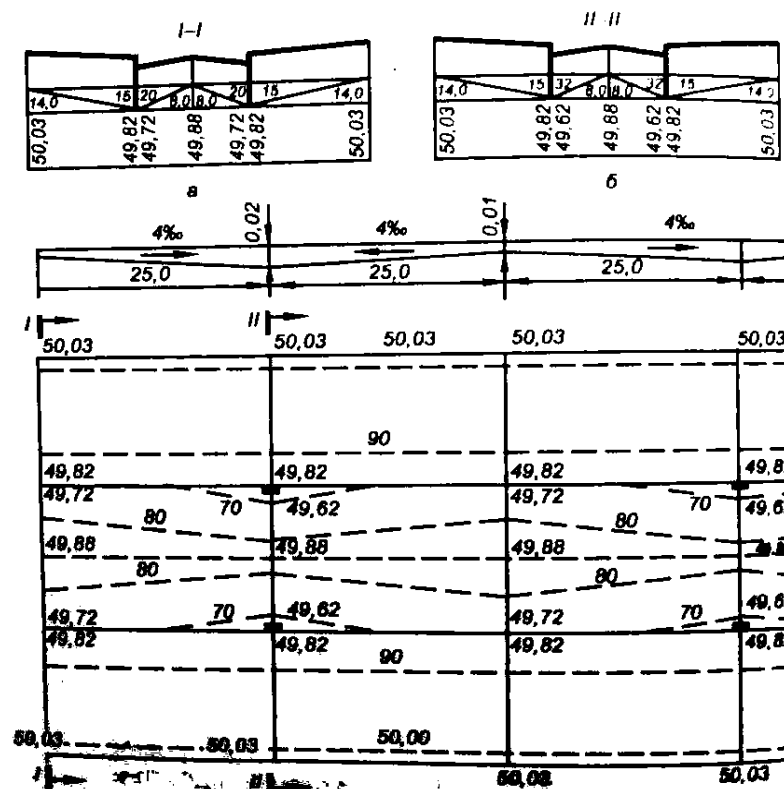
Вертикальне планування поверхні з відсутнім повздовжнім ухилом
